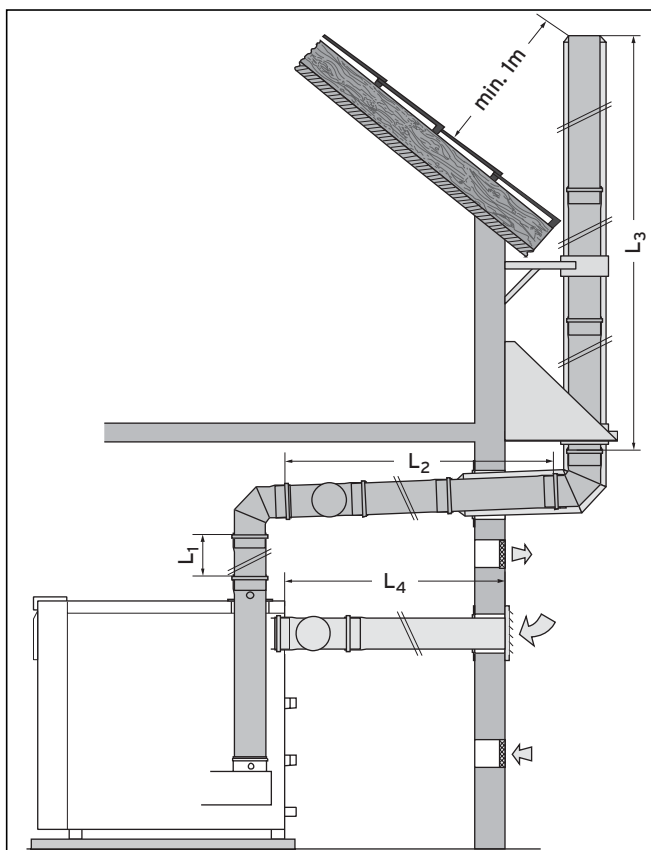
Воздухопровод/газоотвод с забором воздуха не из помещения, дутьевой воздух через наружную стену, отвод отработанных газов на фасаде
